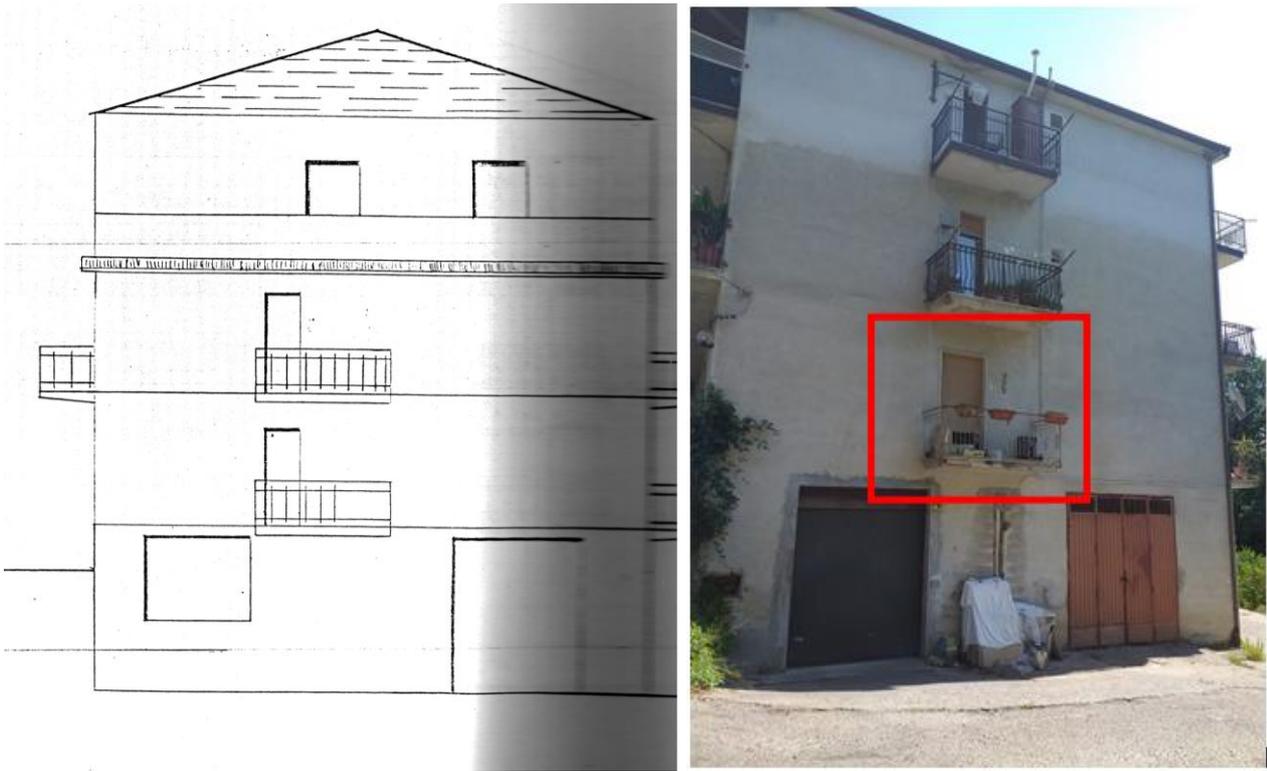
Confronto tra lo stralcio di progetto “Concessione Edilizia n. 69 del 25 agosto 1988” ed il prospetto laterale
